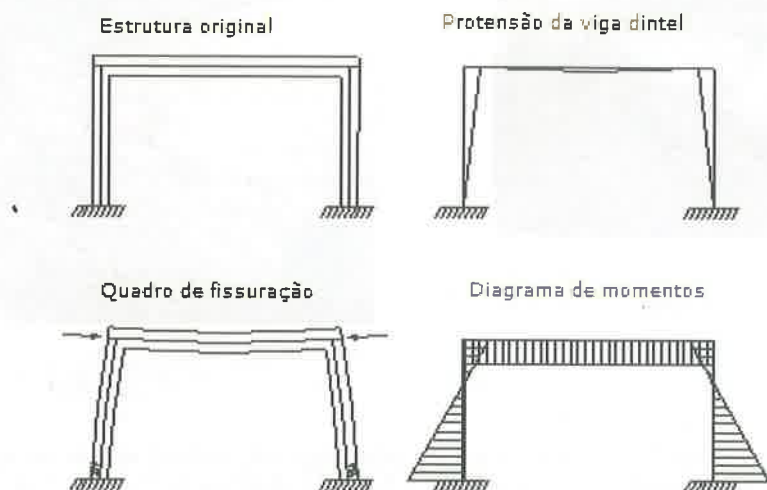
Fissuras em pórticos por ação da protensão
